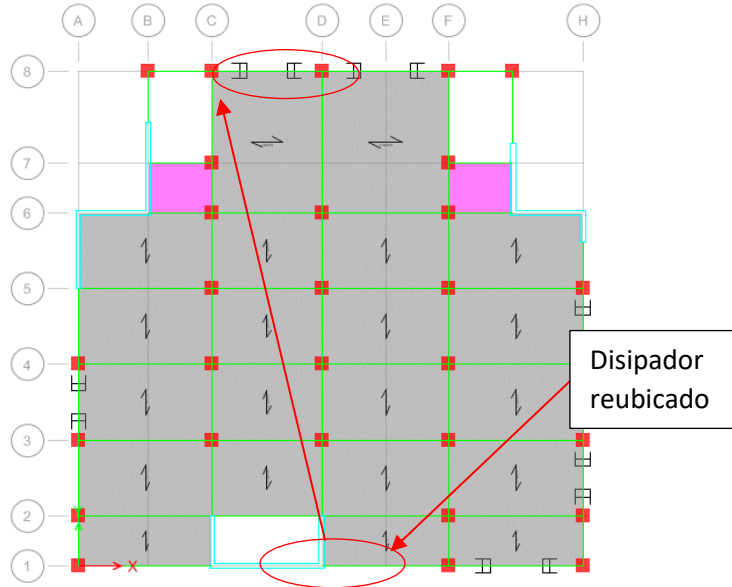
Vista en planta, tercer caso de ubicación de dispositivos
